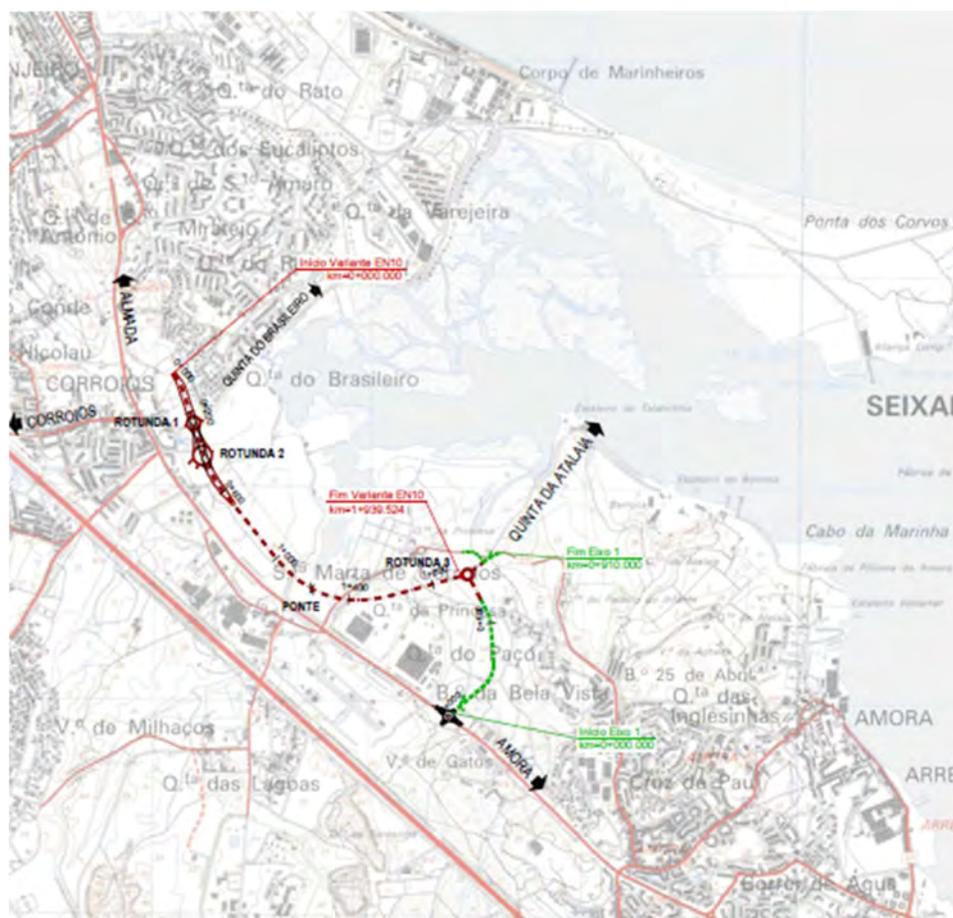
Variante à N10 e via de ligação (EIA, Alternativa EN10, 2021)
